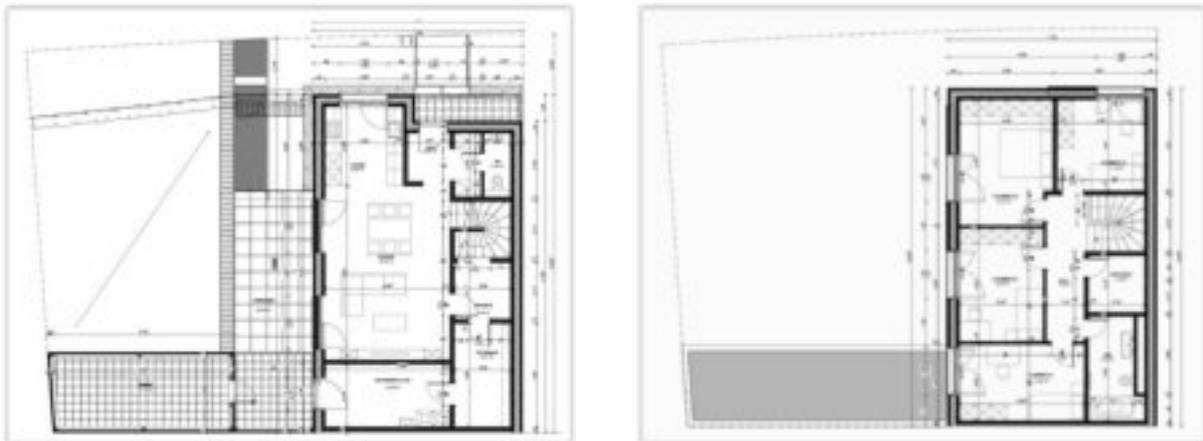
Grundrisse eines Musterhauses (Typ 7) – Erdgeschoss und Obergeschoss
